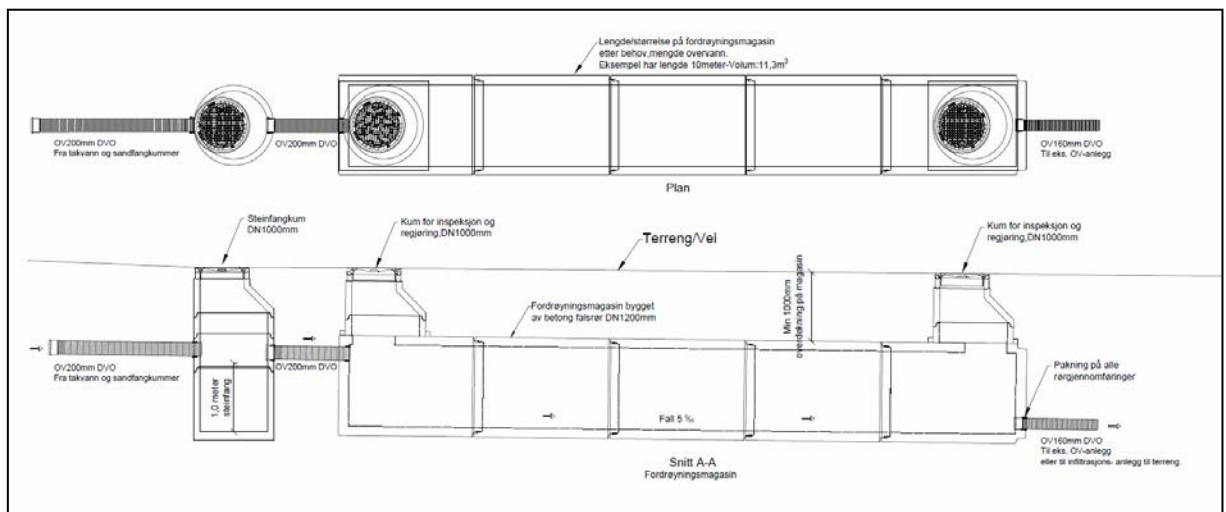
Prefabrikkert fordrøyningsanlegg i betong.
